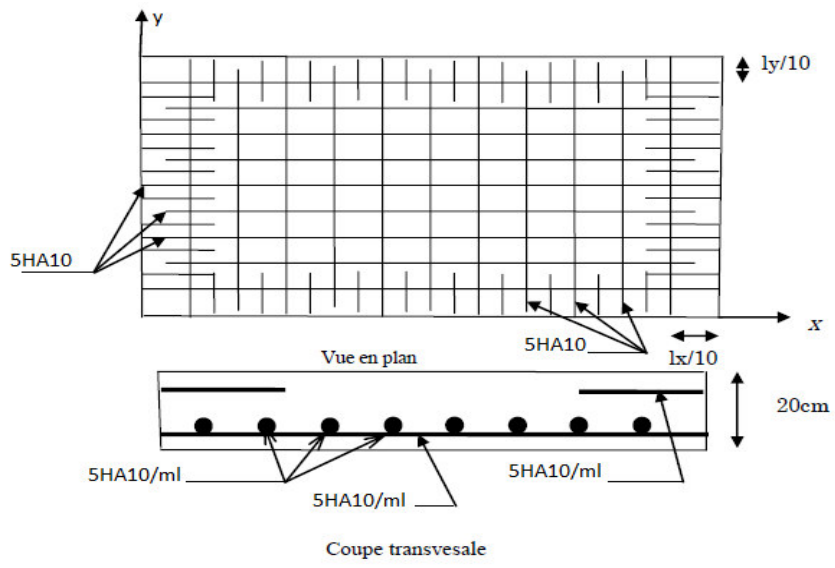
schéma de ferrailage de la dalle d'ascenseur
